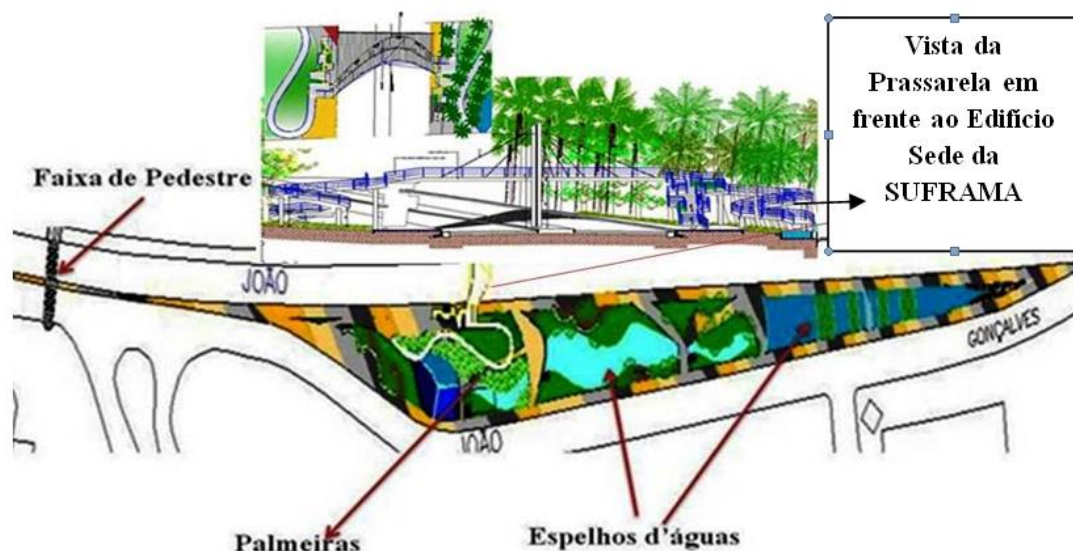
Planta de Layot da 6ª parte. Área enfrente a SUFRAMA (trecho 06).
